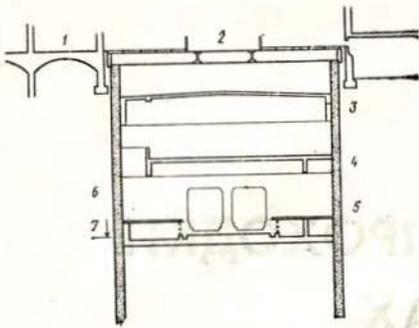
Поперечное сечение котлована с временным перекрытием:
